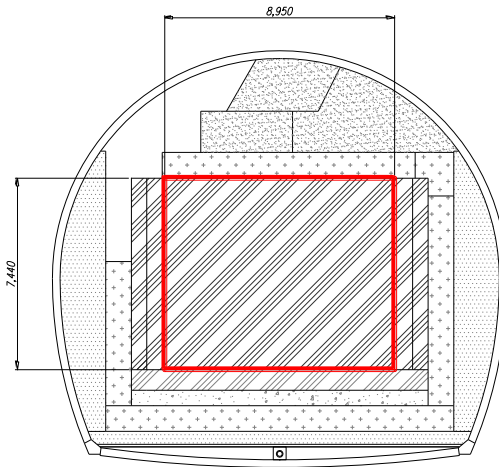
手前コンクリートピットの露出範囲（正面図） [1]
